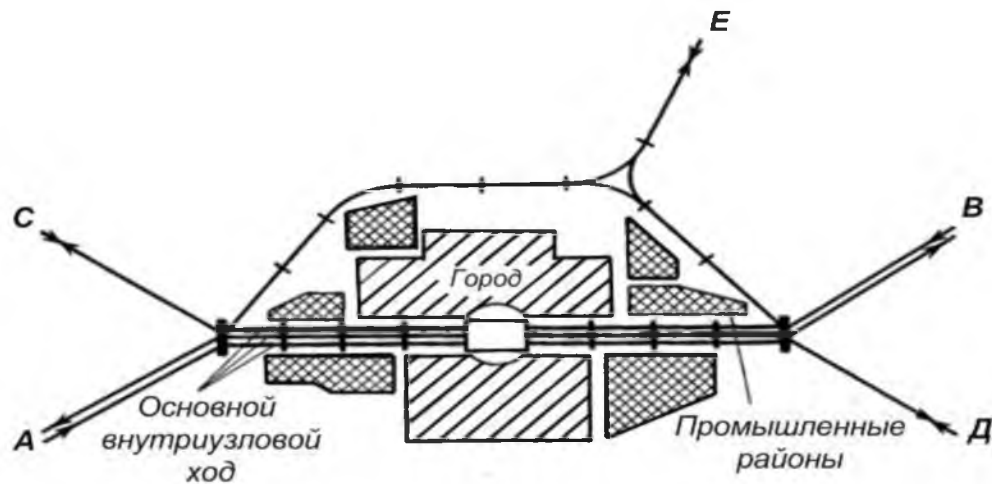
Схема крупного железнодорожного узла с параллельными внутриузловыми ходами
